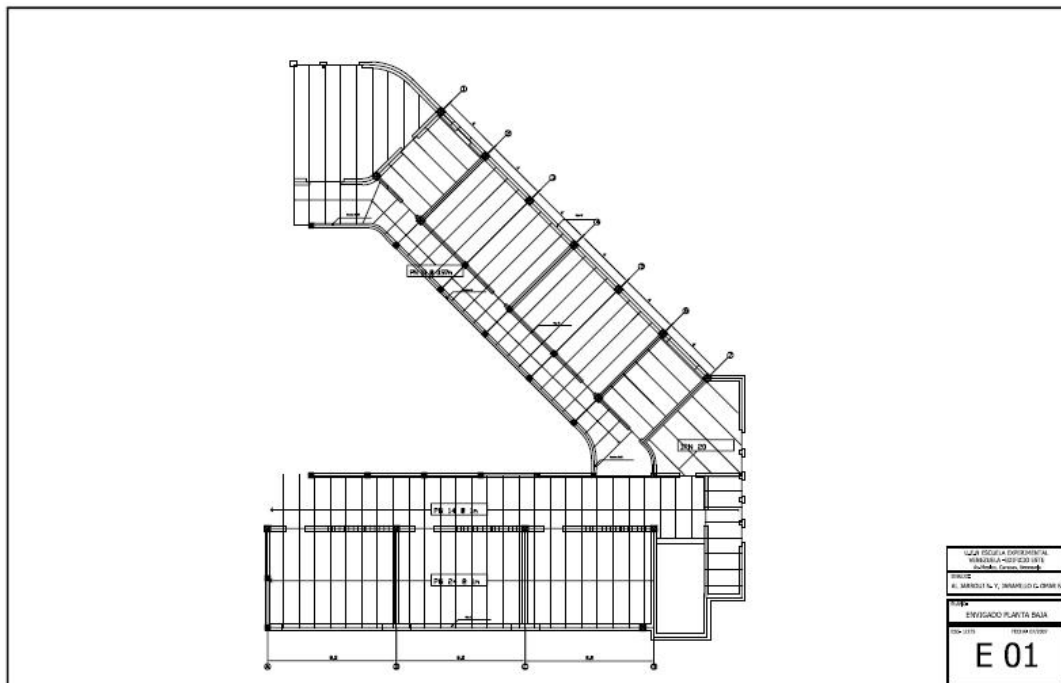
Plano digital de estructura de la planta baja del edificio este
